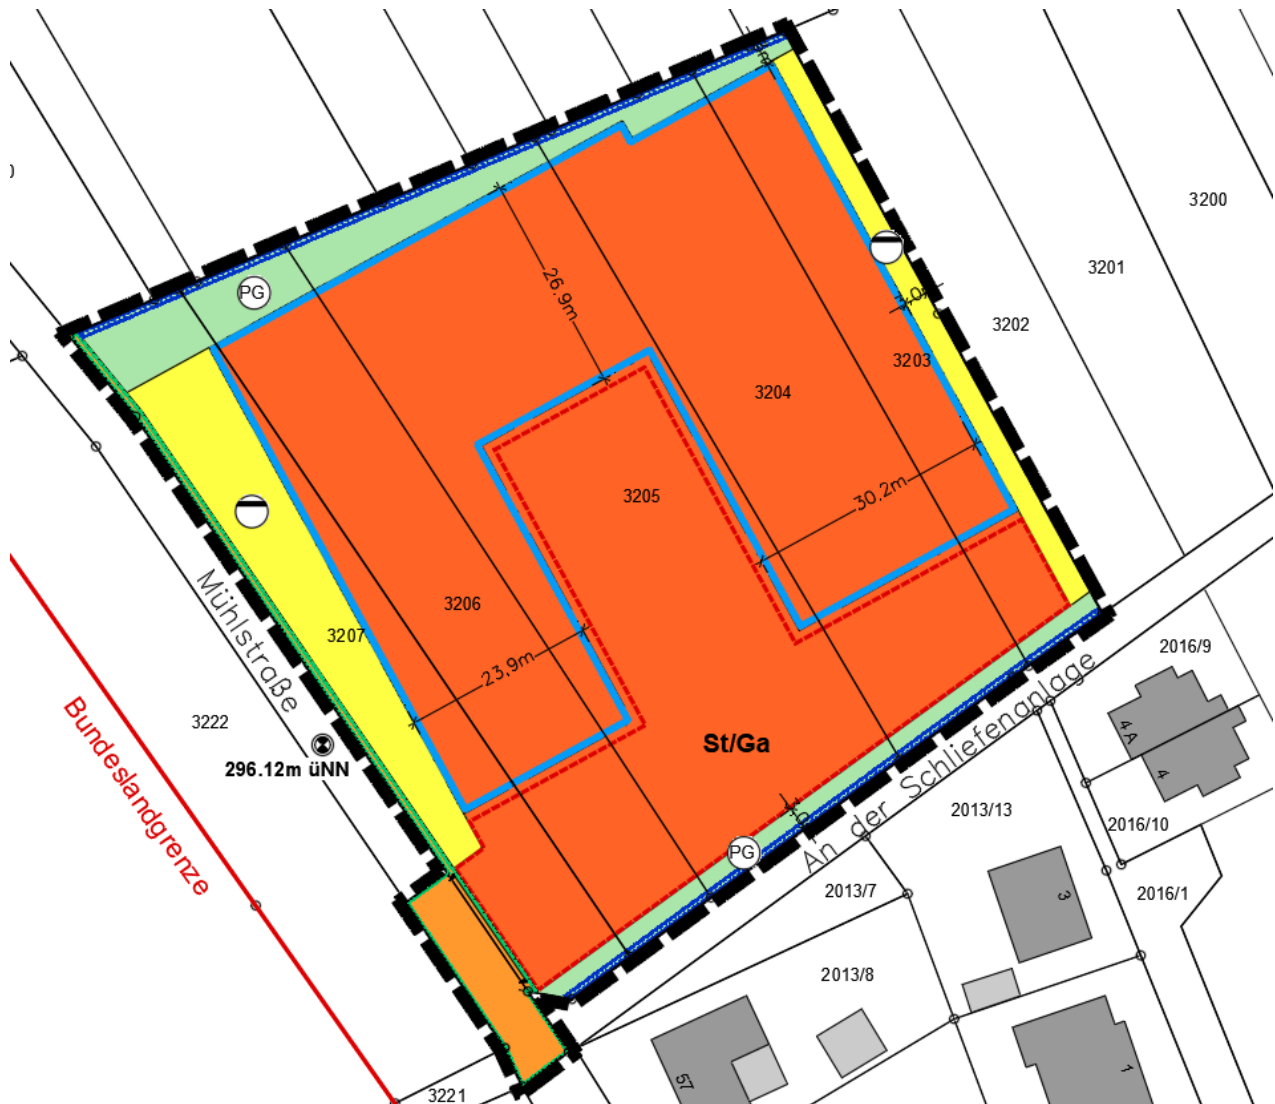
Ausschnitt aus dem Bebauungsplan, Mai 2025 [2]
